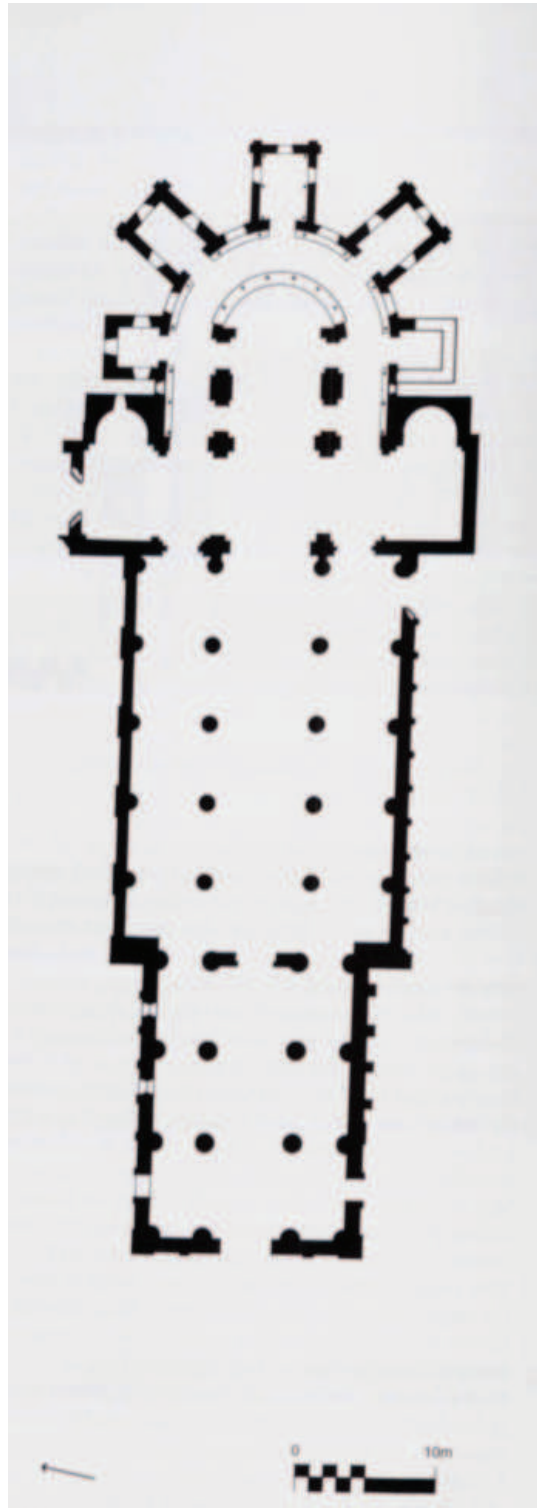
Tournus, St. Philibert, Grundriss.
